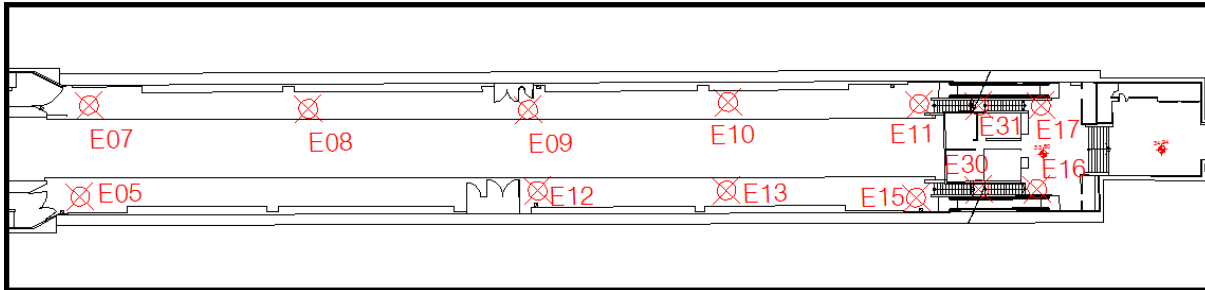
Plano situación estacionamientos escaneos (zona de vías, andén y escaleras de acceso).
